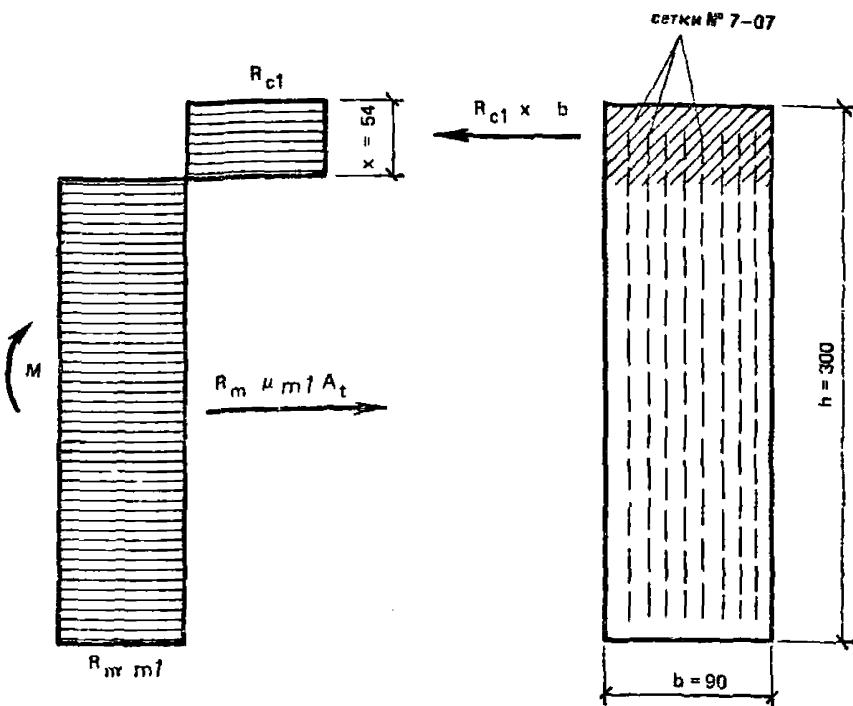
Схема усилий и эпюра приведенных напряжений в изгибающем элементе прямоугольного сечения, армированного ткаными сетками
